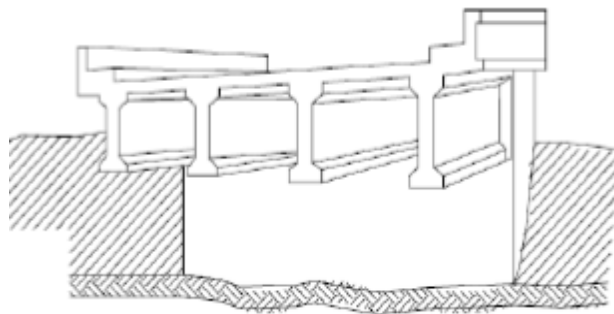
Puente de losa con viga pretensada (Fuente: Aranis)
